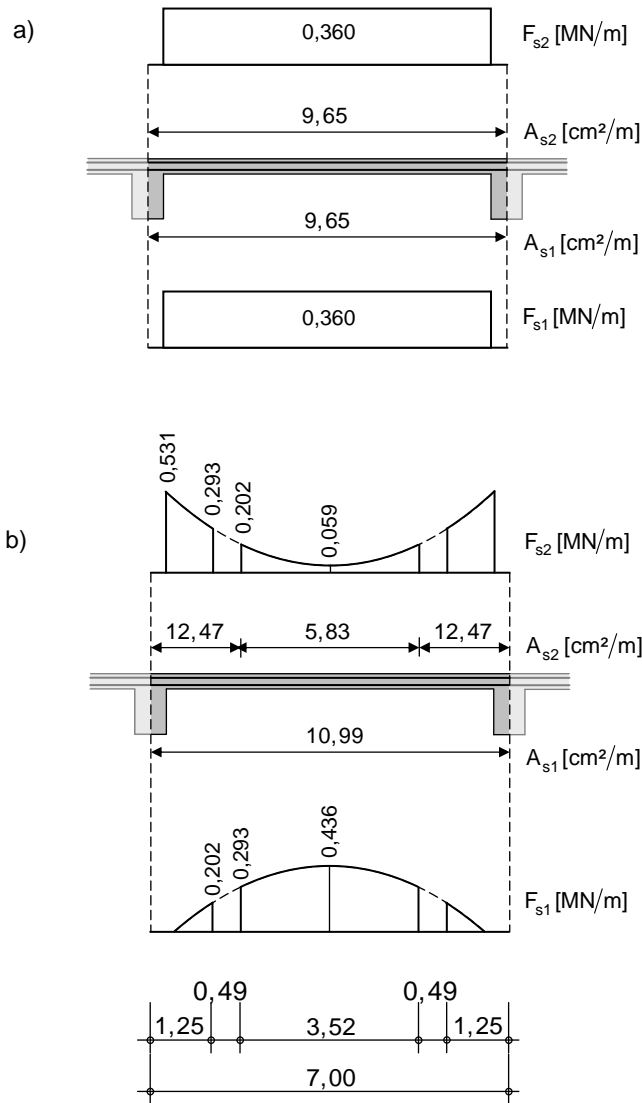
Von den Bewehrungslagen aufzunehmende Zugkräfte F_{s1} bzw. F_{s2} und erforderliche Bewehrung zur Beschränkung der Rissbreite bei getrennter Behandlung (a) und bei Überlagerung (b) der Beanspruchungen aus äußerer Last und Zwang
